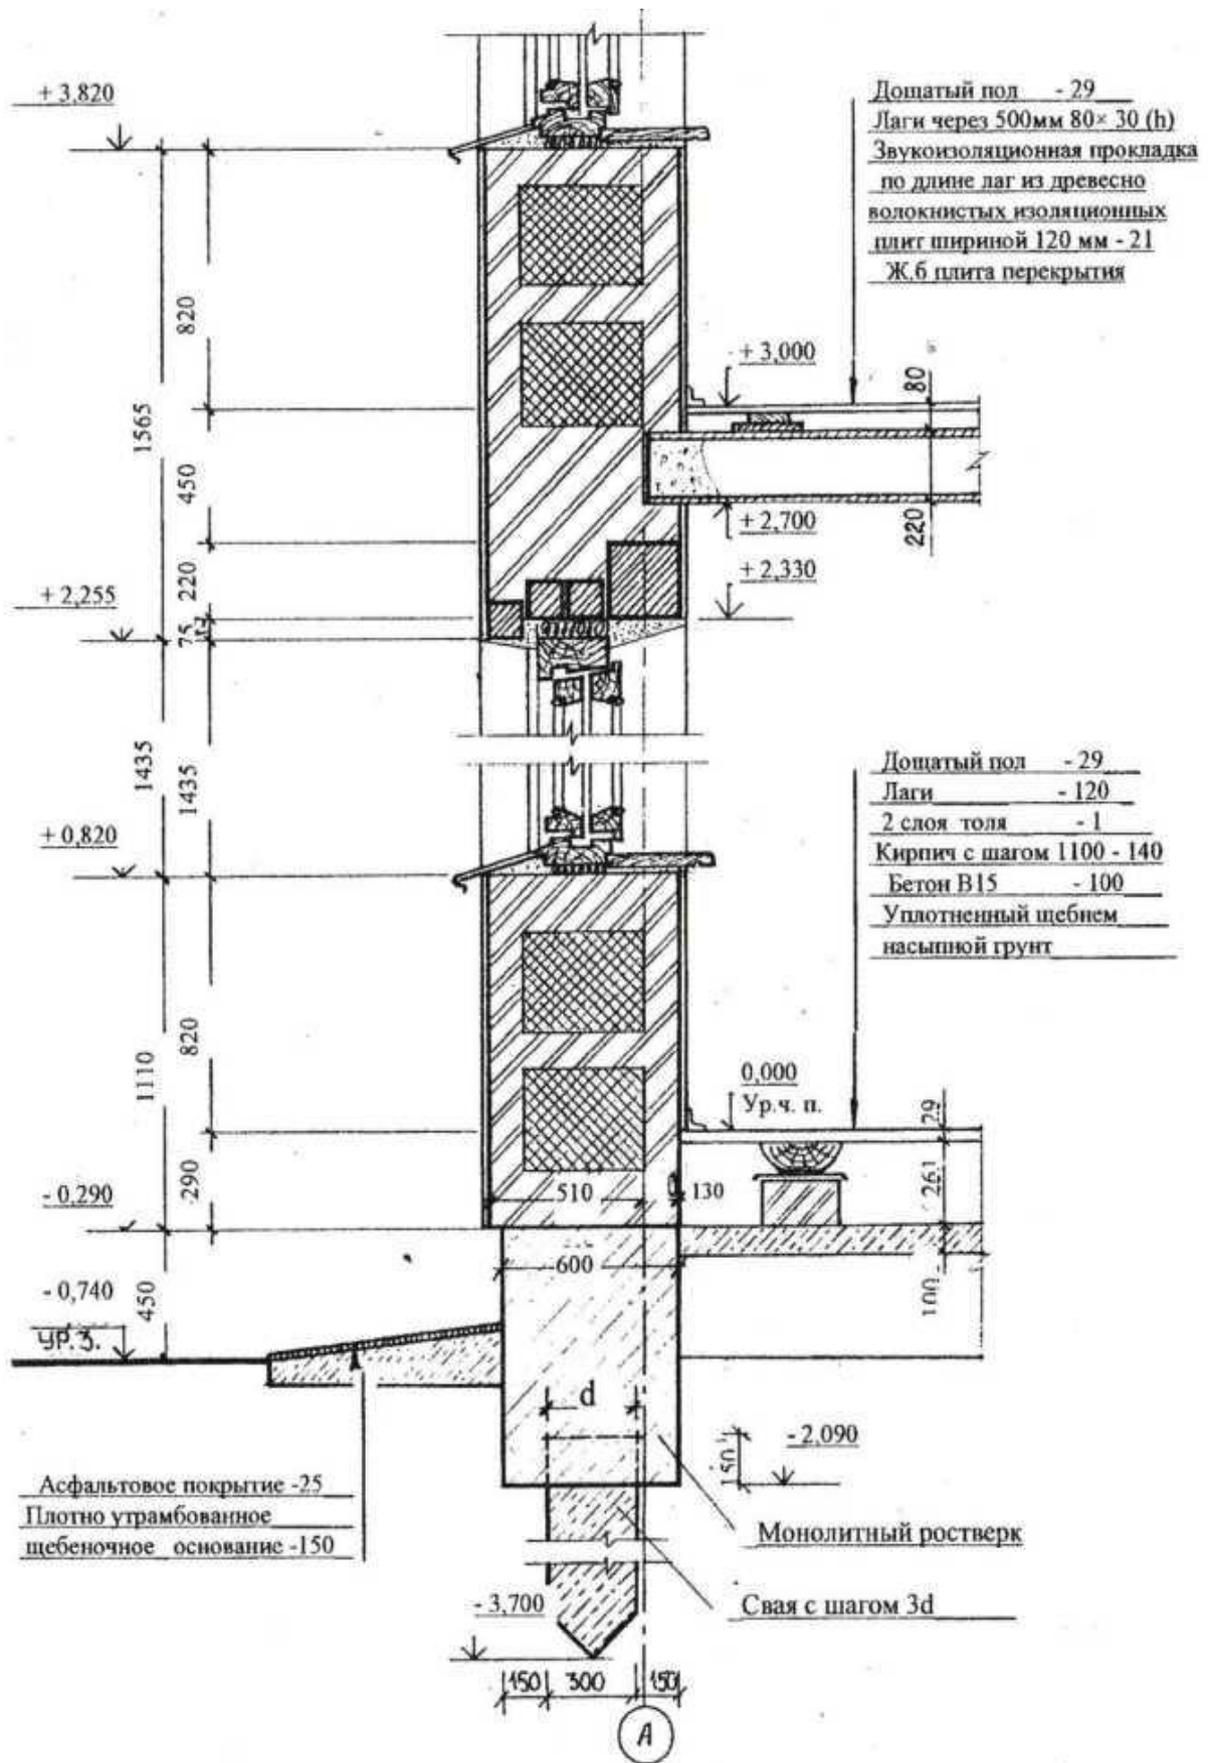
Конструктивный разрез по кирпичной стене со свайными фундаментами
